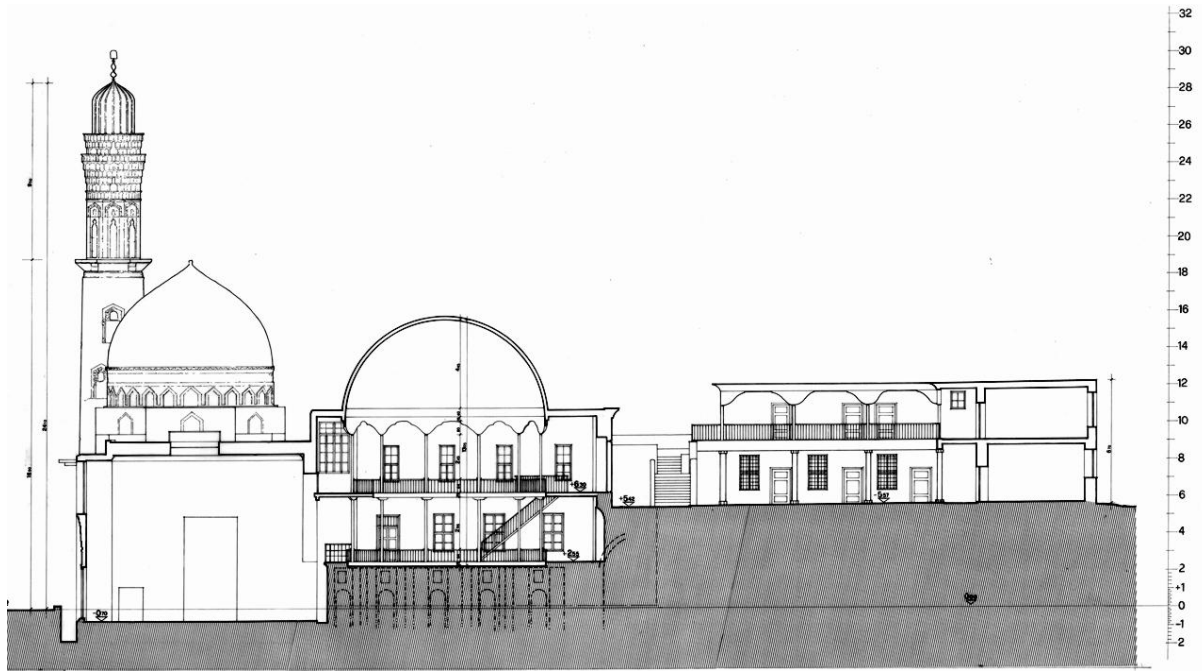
Sezione A-A de la Fachada del Complejo (Fuente: <http://www.cfpr.it/PLANIMETRIE%202009/Section.htm>)
